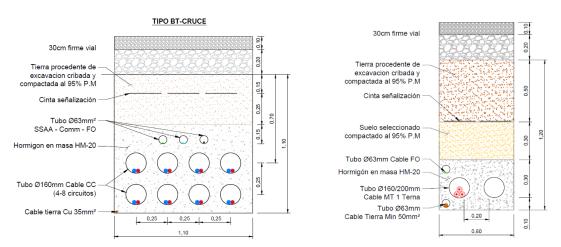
Detalles de las zanjas tipo cruce para BT (izda.) y MT (dcha.)
